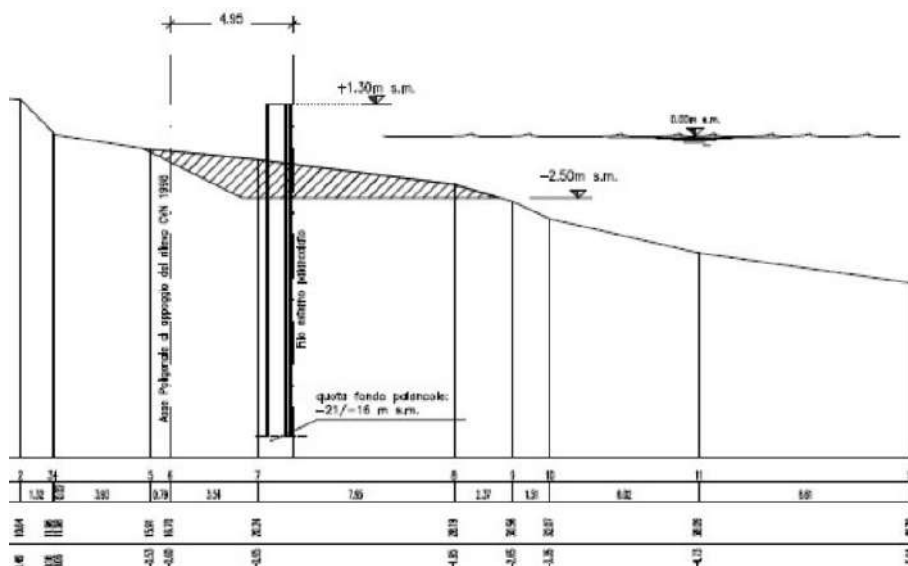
Sezione con indicazione della quota del fondale attuale e del posizionamento delle palancole – particolare
